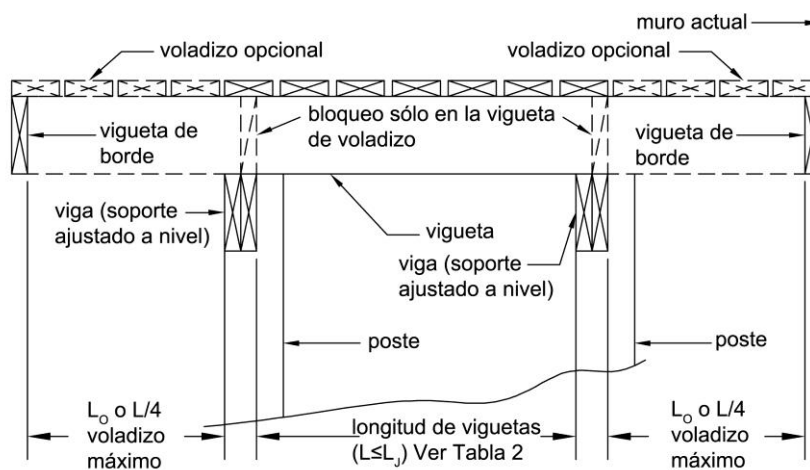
Longitud de Viguetas – Cubiertas sin Largueros.
